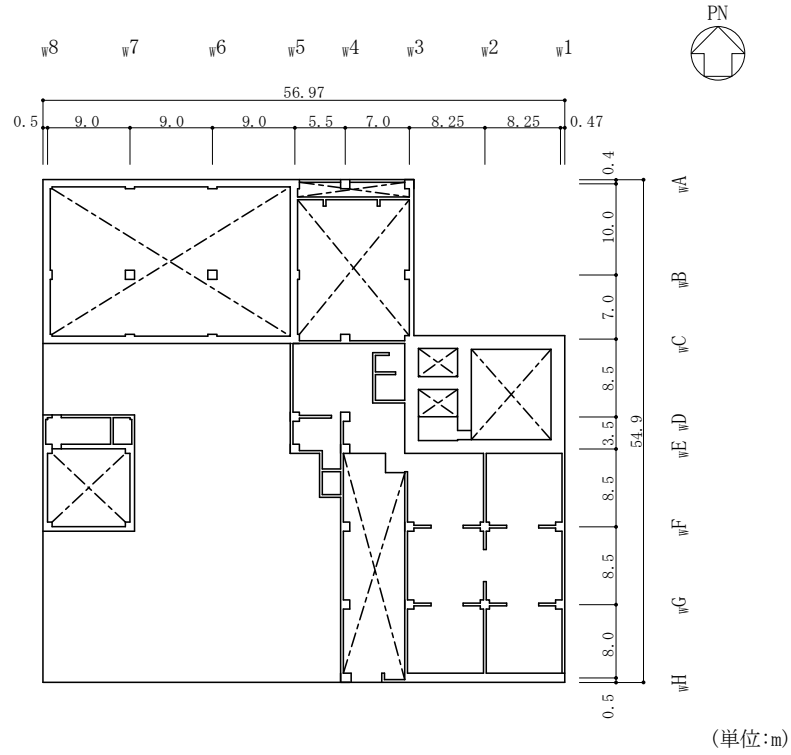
(8) 廃棄物処理建物の概略平面図 (EL 37.5m)
